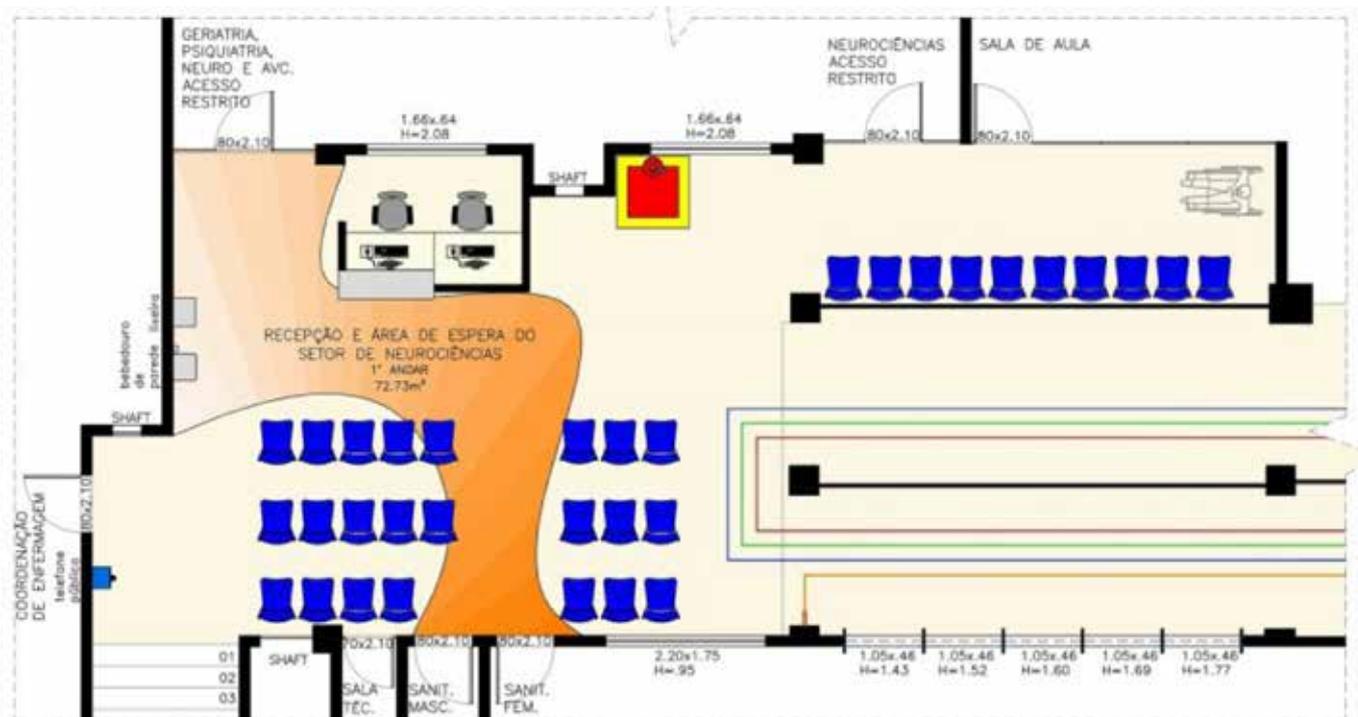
Proposta em planta baixa da intervenção no ambiente estudado.
